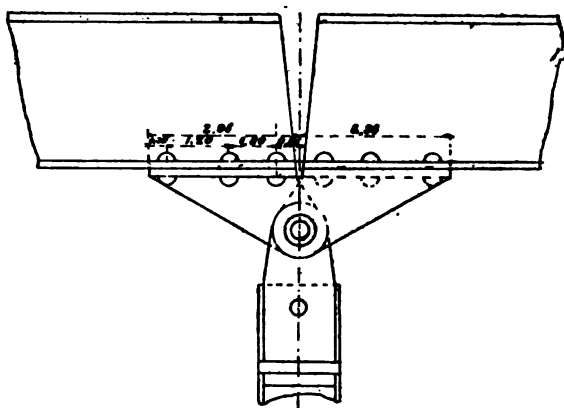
Canal de Manchester. — Joint du support de la plateforme.
